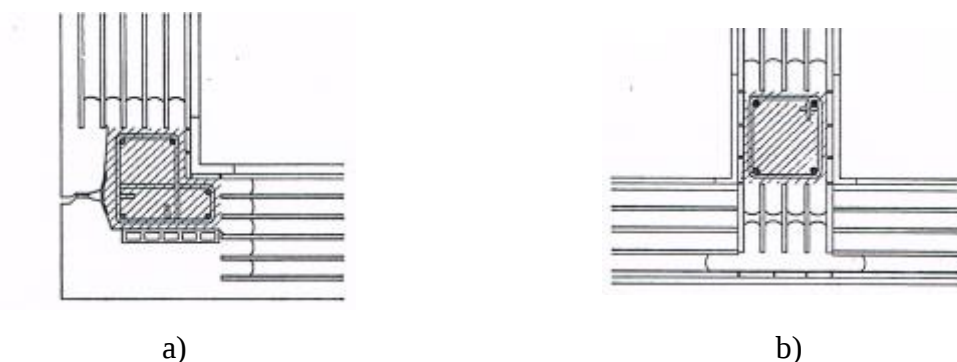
Pormenores de montantes: a) De cunhal; b) painel interior com outro painel disposto perpendicularmente (LNEC, 1968).
